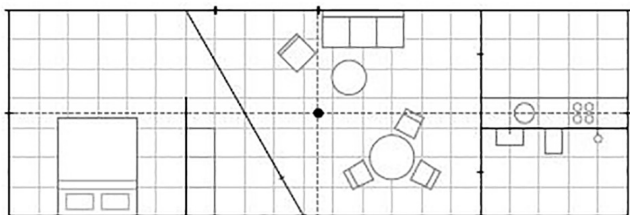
Planta base projeto 140b, de Fala Atelier, 2016.
